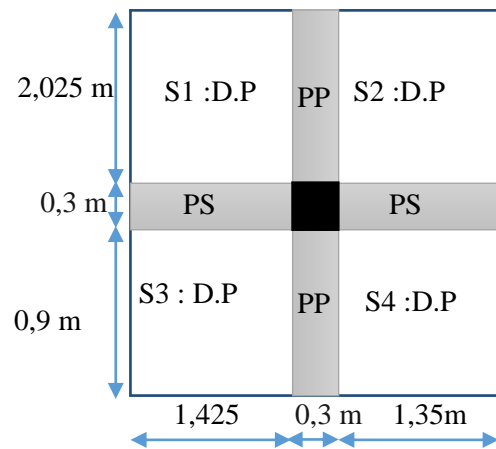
Surface afférente du niveau 7 -> entre sol 1
